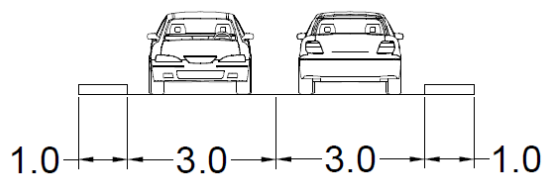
Sección Transversal Vías categoría No. 2.2. (Fuente: Elaboración Propia).
